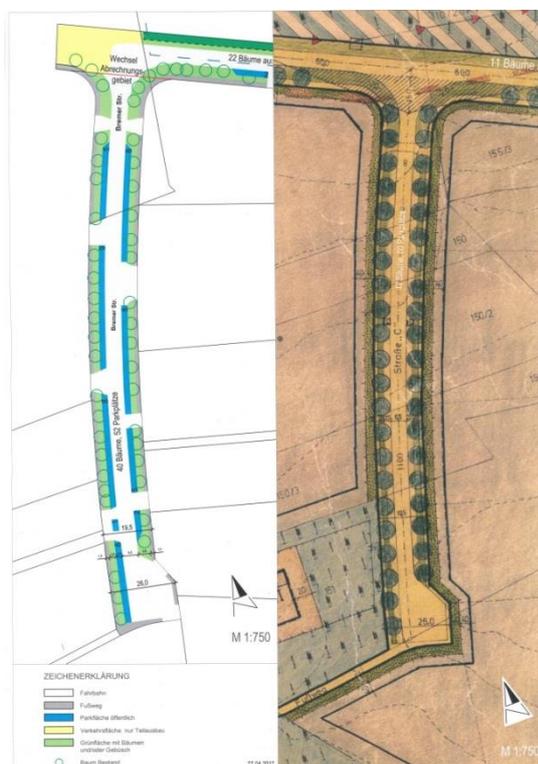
Straßenausbau Bebauungsplanausschnitt P-5-75- Bereich Bremer Straße
